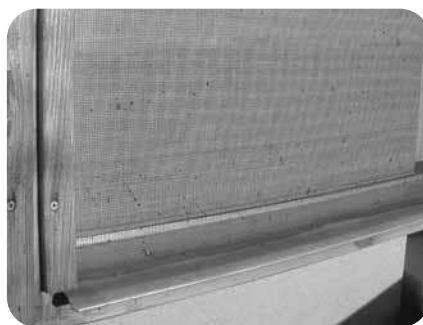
Detail zevnitř otevřeného okenního výkluzu zjednodušené konstrukce bez drátěné výztuhy dolního okraje sítky (foto Přidal).
